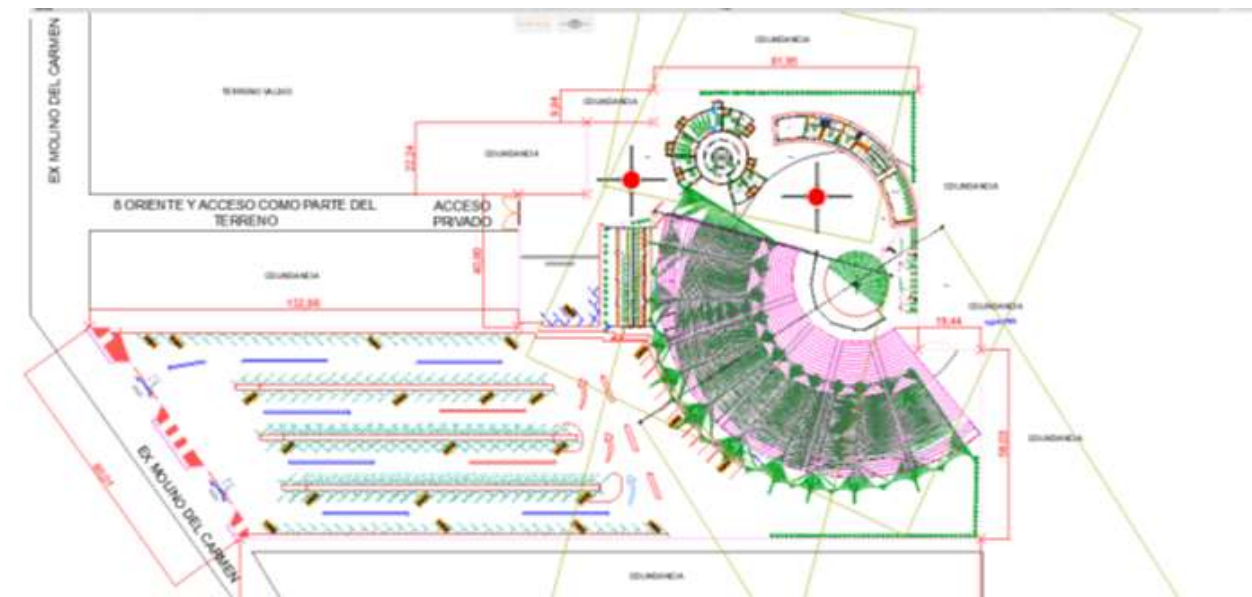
PLANTA DE CONJUNTO. AROCHE TORRES 2022.
